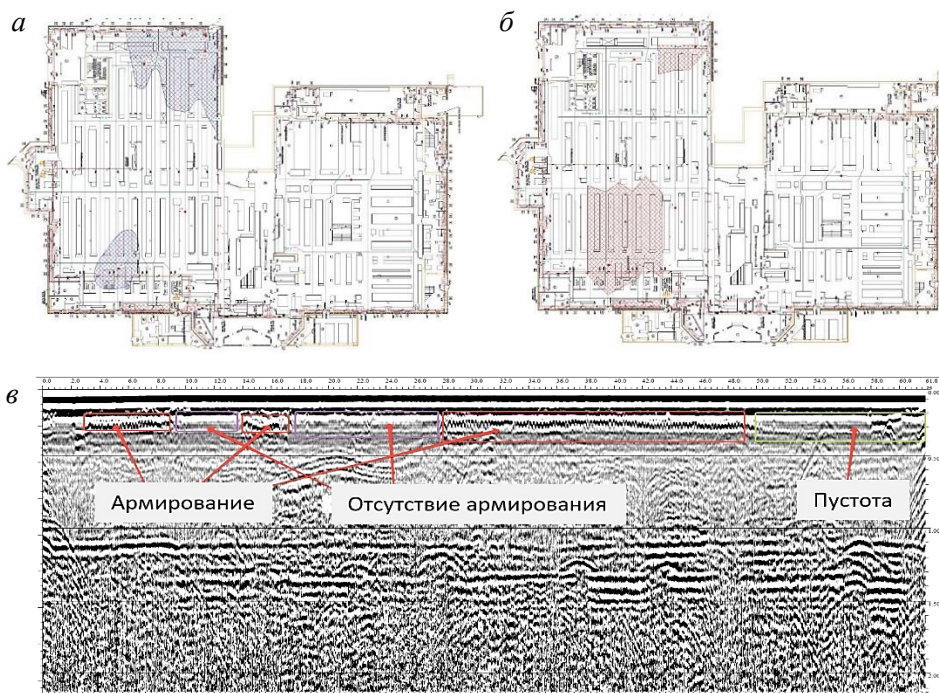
Схема расположения выявленных пустот (а) и участков без армирования (б) под ж/б плитой; продольный разрез (в)
